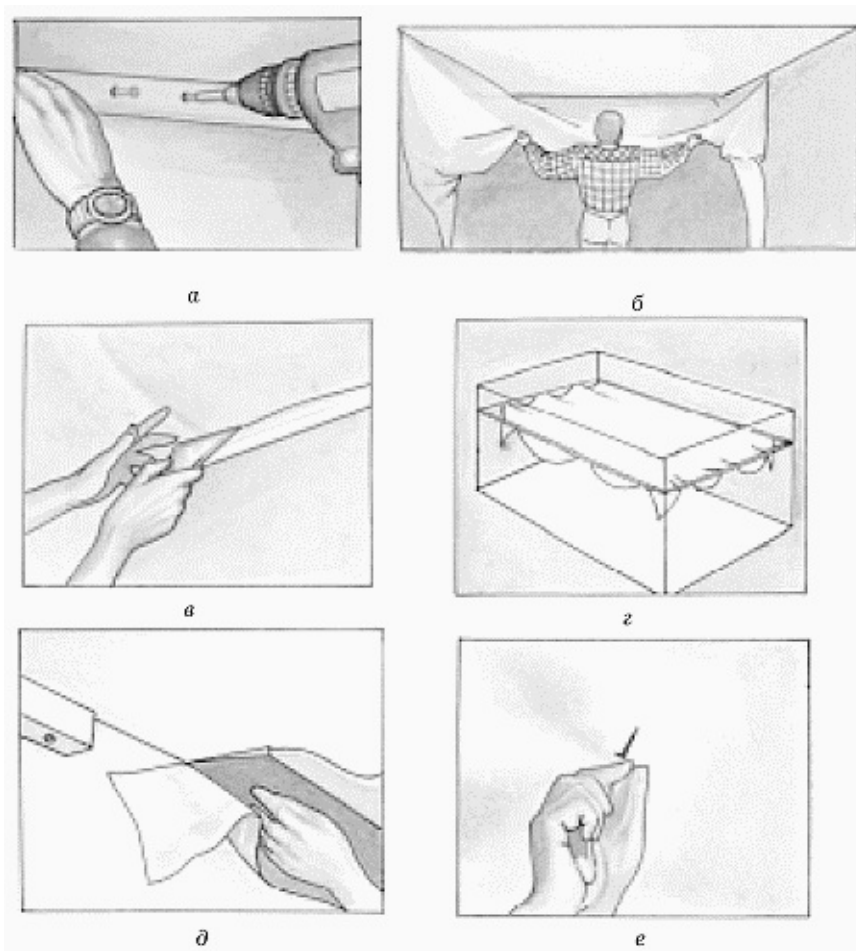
Установка потолка фирмы „Clipso": а – крепление багета; б – развешивание полотна; в – заправка полотна; г – натяжка; д – обрезка; е – установка осветительных приборов.
